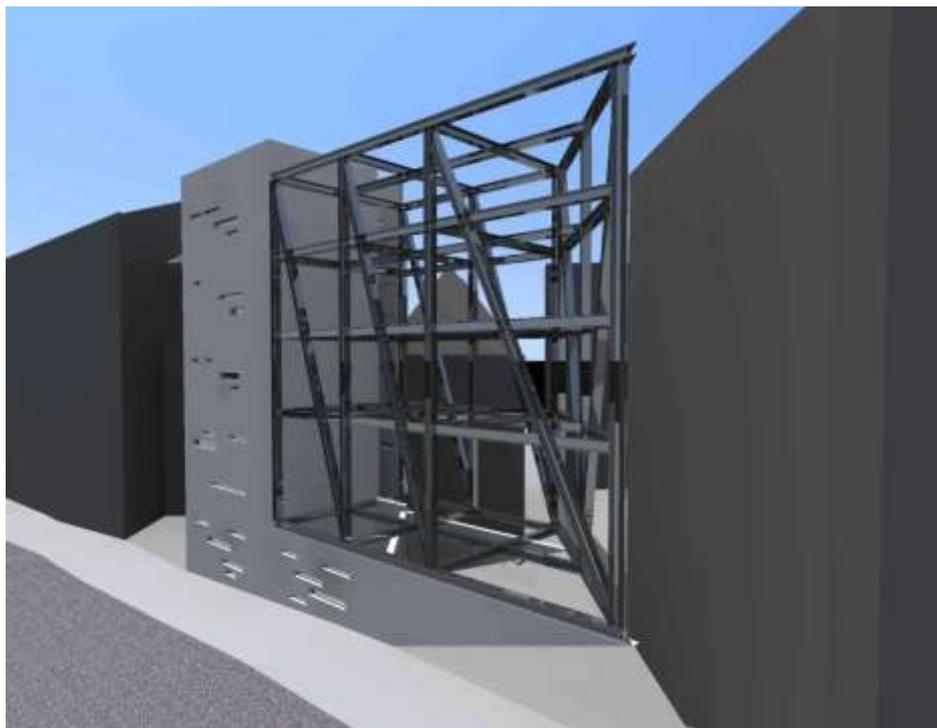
Detalhe construtivo da consola. (Ilustração
